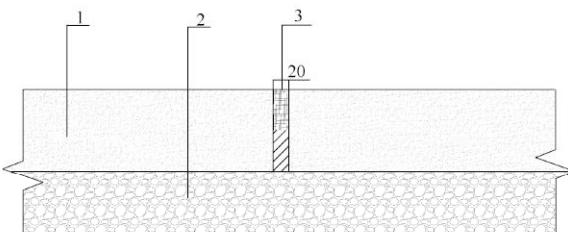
全透水水泥混凝土路面胀缝构造（单位：mm）
